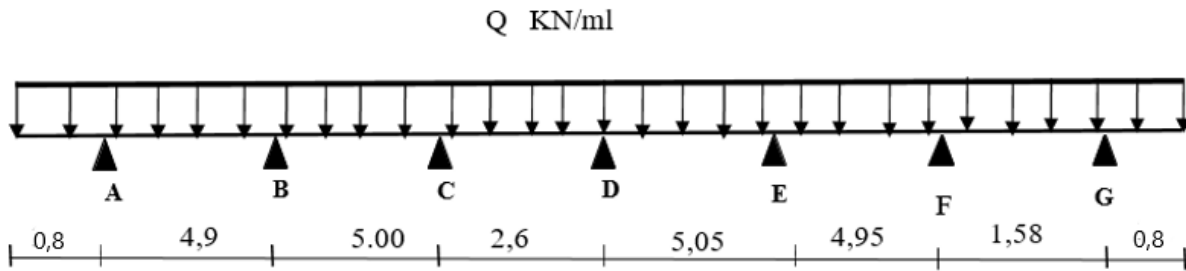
Schéma statique d'une poutre de rigidité.
